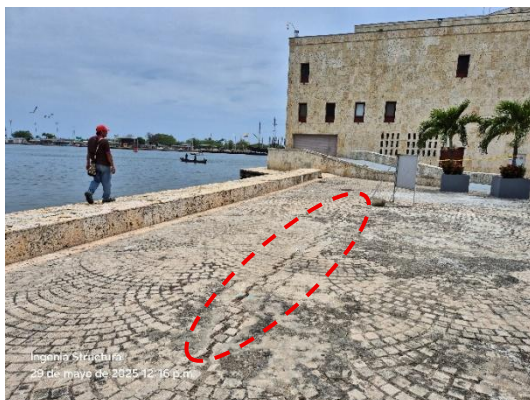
Vista general del sector 5 lado tierra. Grieta visible en el adoquinado
